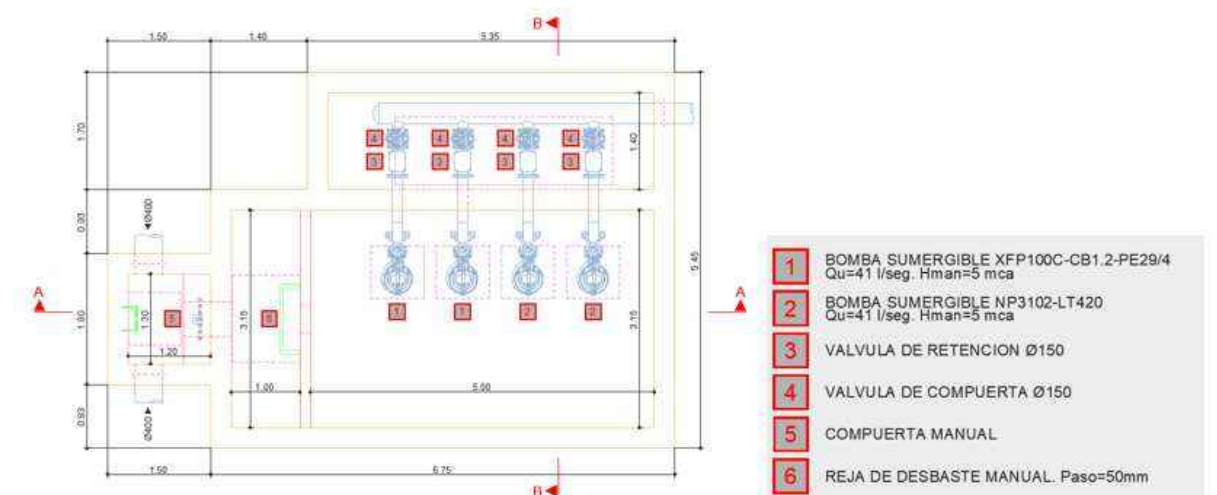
EBAR Praza do Regueiro. Planta equipos-geometría
